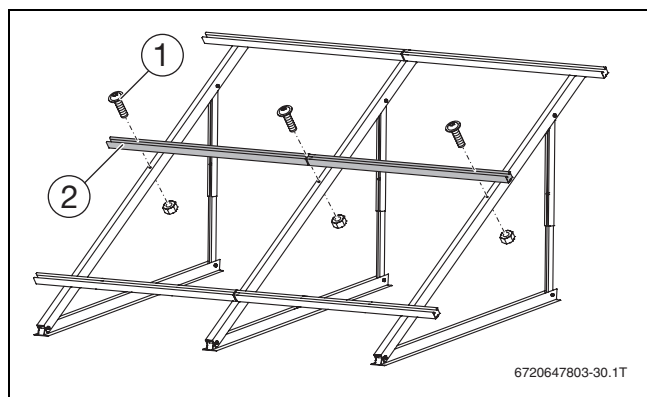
Montagem das calhas de perfil adicionais (aqui: 2 colectores verticais)
